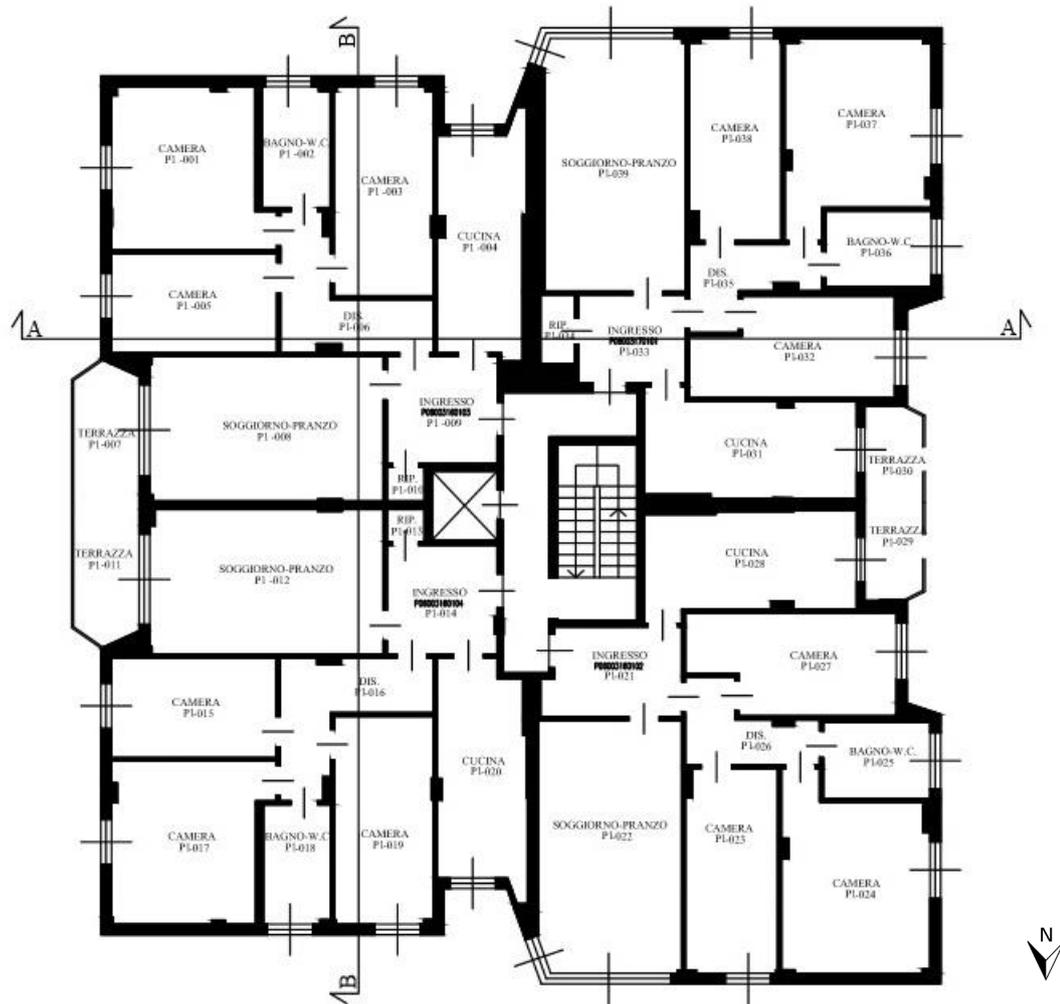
Pianta piano primo, via Brofferio, 1. Scala 1:200. Fonte: Ater Padova.
